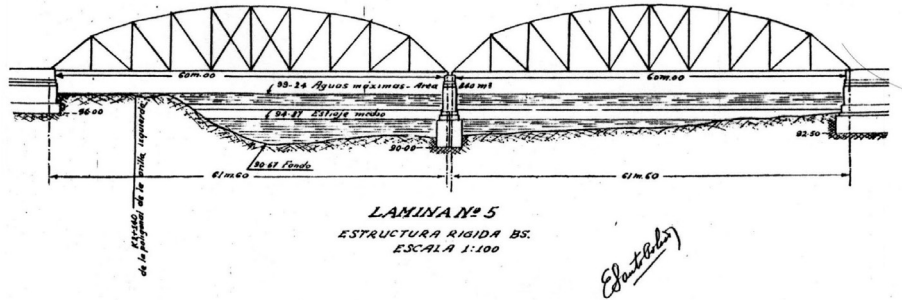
Propuesta de estructura rígida, tipo Pennsylvania.
